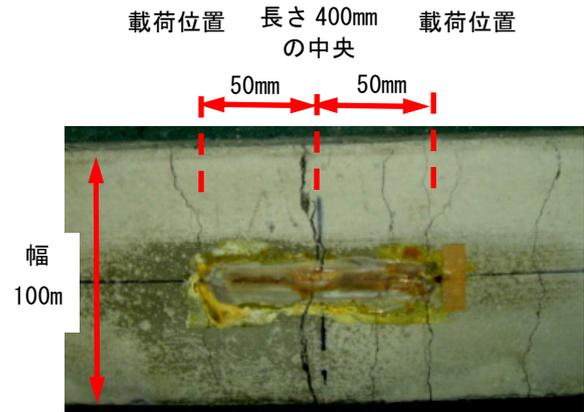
は、各種コンクリート・モルタルで製作した供試体を使用し、曲げ強度（タフネス）試験（JSCE-G552）を行った後、その供試体の下面に発生したひび割れ状態を示している。供試体は、一般的な100×100×400mmの角柱状のものであり、3等分点荷重によって試験を実施している。写真-1(d)の供試体に発生したひび割れは微細であるため、供試体の中央部を拡大している。ただし、ひび割れが相当に微細であるため、写真では確認できないひび割れが多数存在している。
